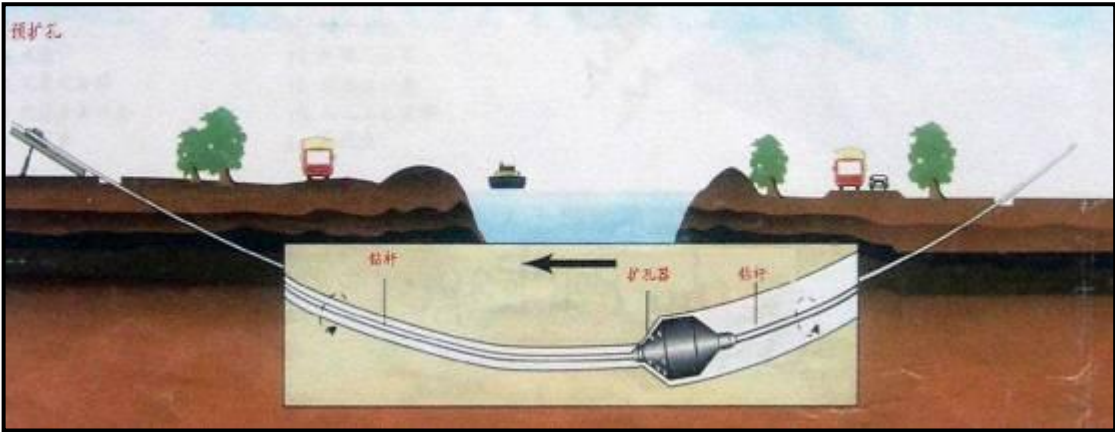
定向钻穿越施工预扩孔过程断面示意图
